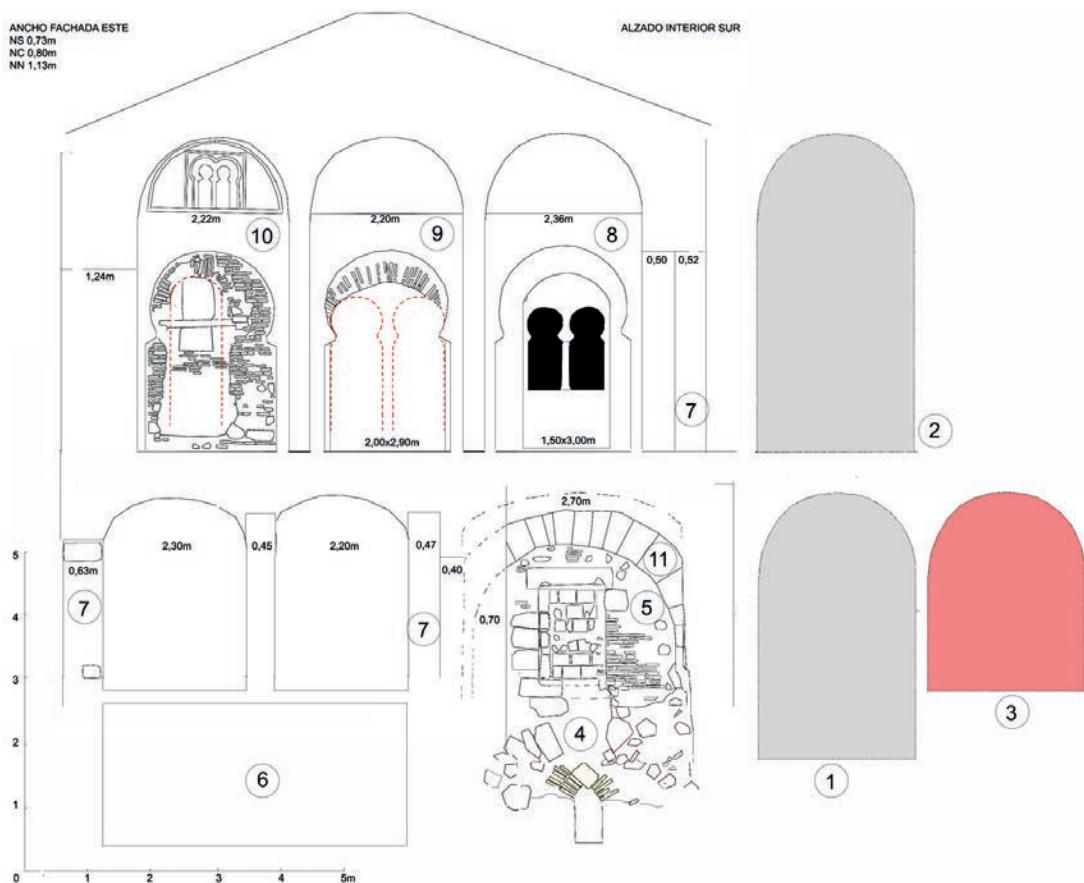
1. ALZADO DE BÓVEDA, PLANTA BAJA (FASE B); 2. ALZADO DE BÓVEDA, PLANTA PRIMERA (B); 3. ALZADO DE BÓVEDA, PLANTA BAJA (B1); 4. RECRECIDO SUELO, FASE B1; 5. ACCESO PATIO, FASE B1; 6. SÓTANO, FASE B1; 7. DOBLE HOJA; 8. VENTANA PATIO; 9. MIHRAB; 10. CHIMENEA (FASE B4); 11. ARCO EDIFICIO A
